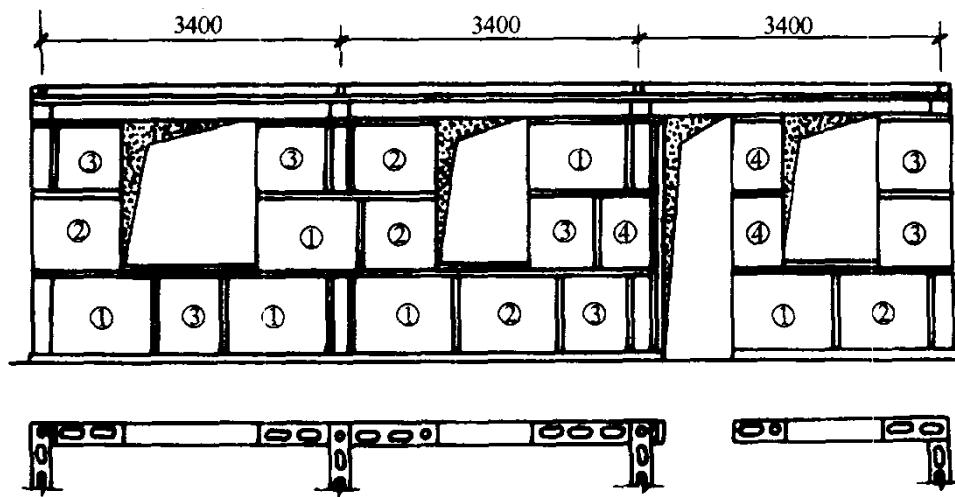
混凝土中型空心砌块砌筑的外墙及其平面示意图
